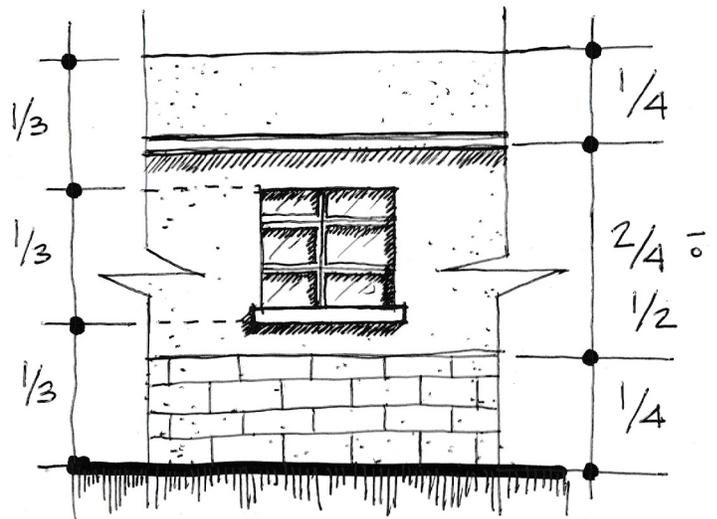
Esquema de Proporciones para las fachadas respecto al frontón y el zócalo.
